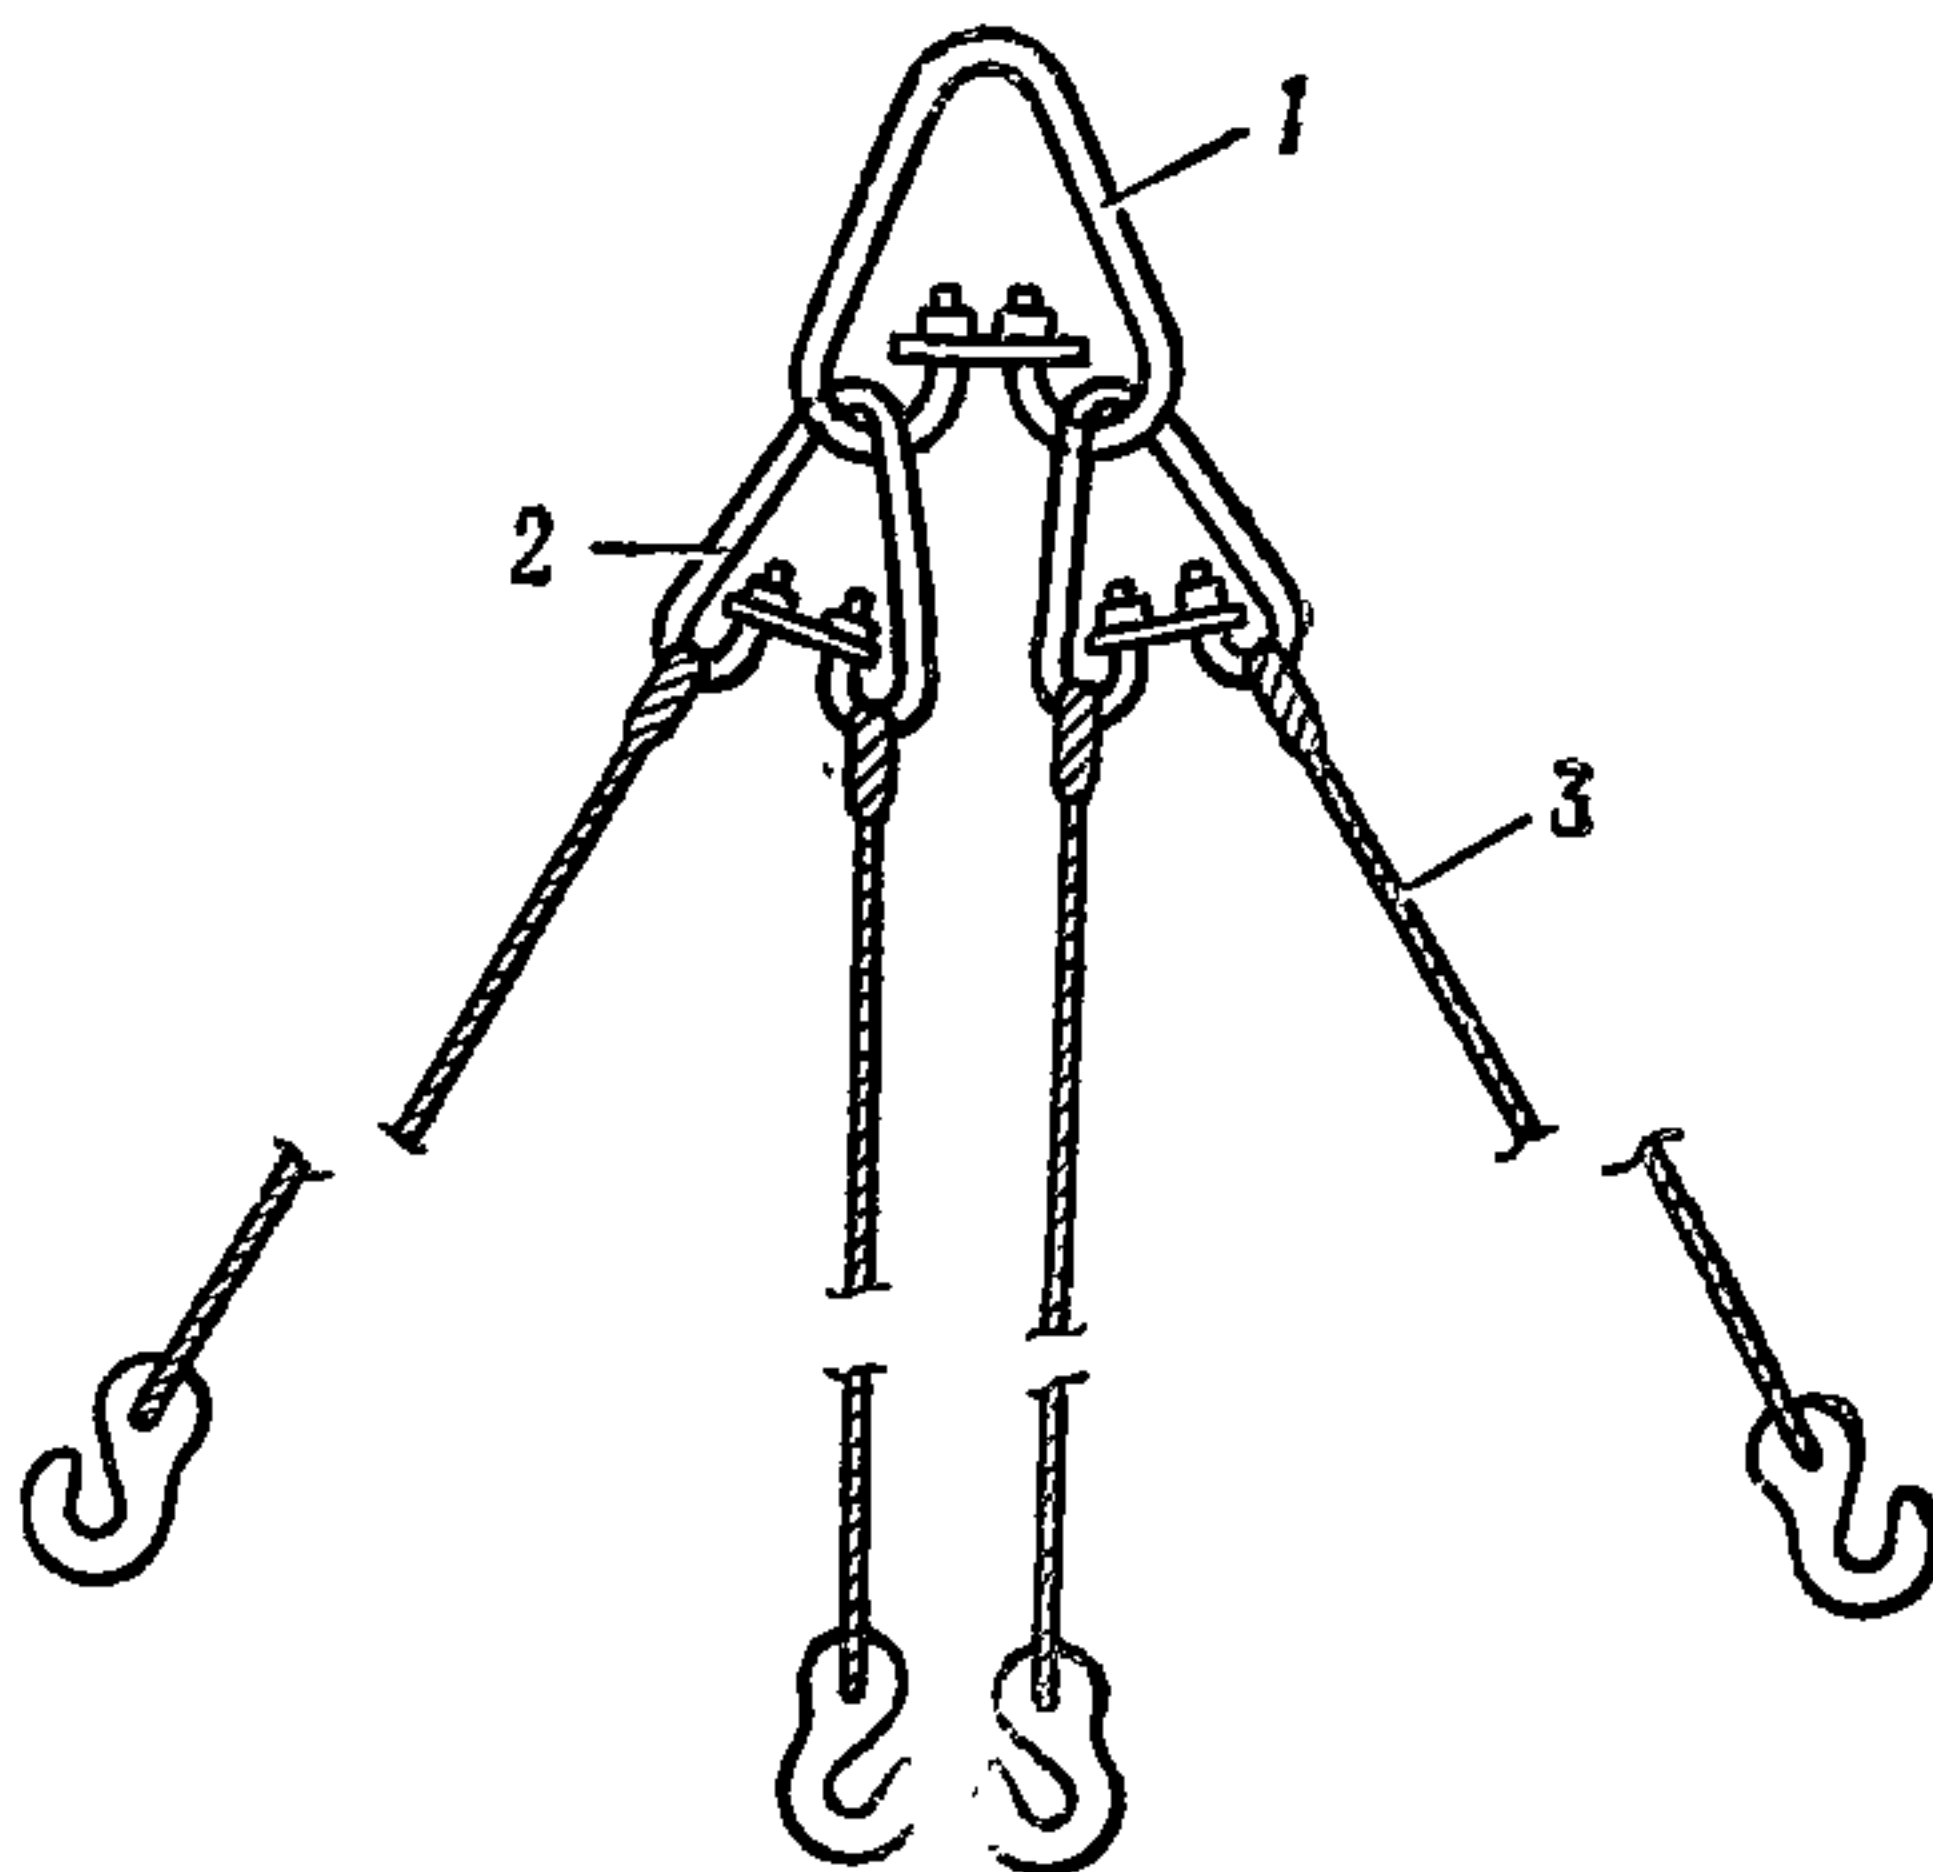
Траверса «паук» для монтажа крупных бетонных блоков:
